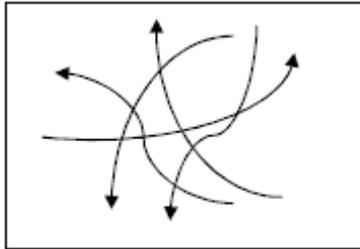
Dirección del espatulado. 2014. Guía aplicación TopCiment.
